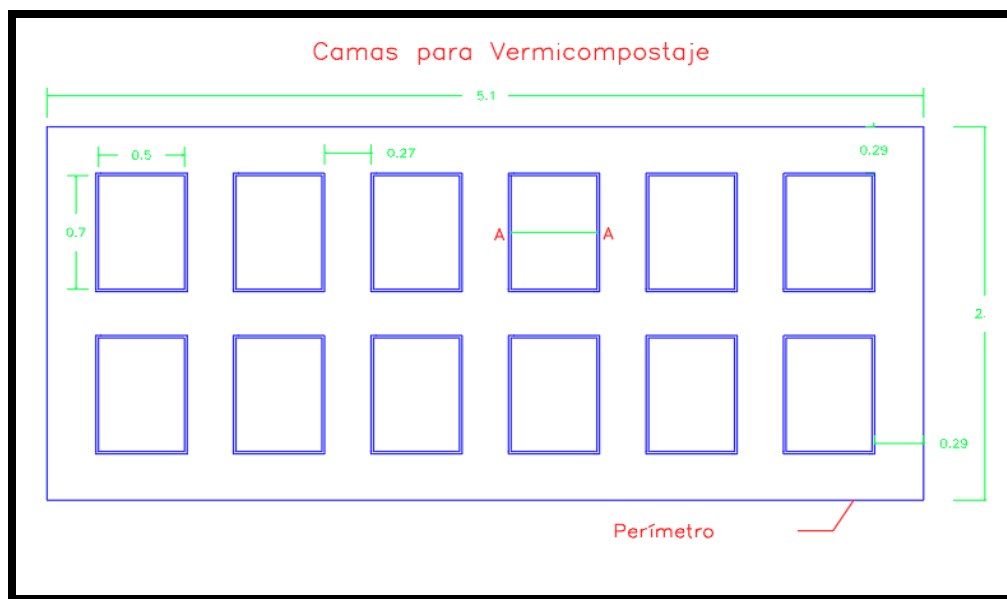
Diseño de las camas para el vermicompostaje, vista de planta.
